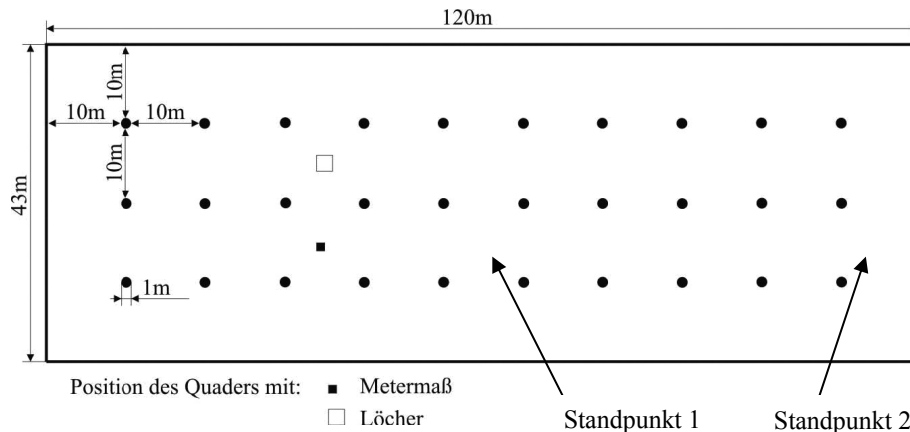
Grundriss des gewählten Modells
